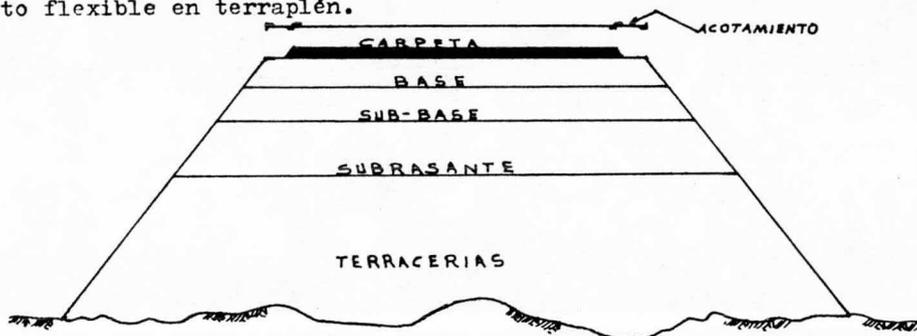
Sección típica de un pavimento flexible en terraplén
